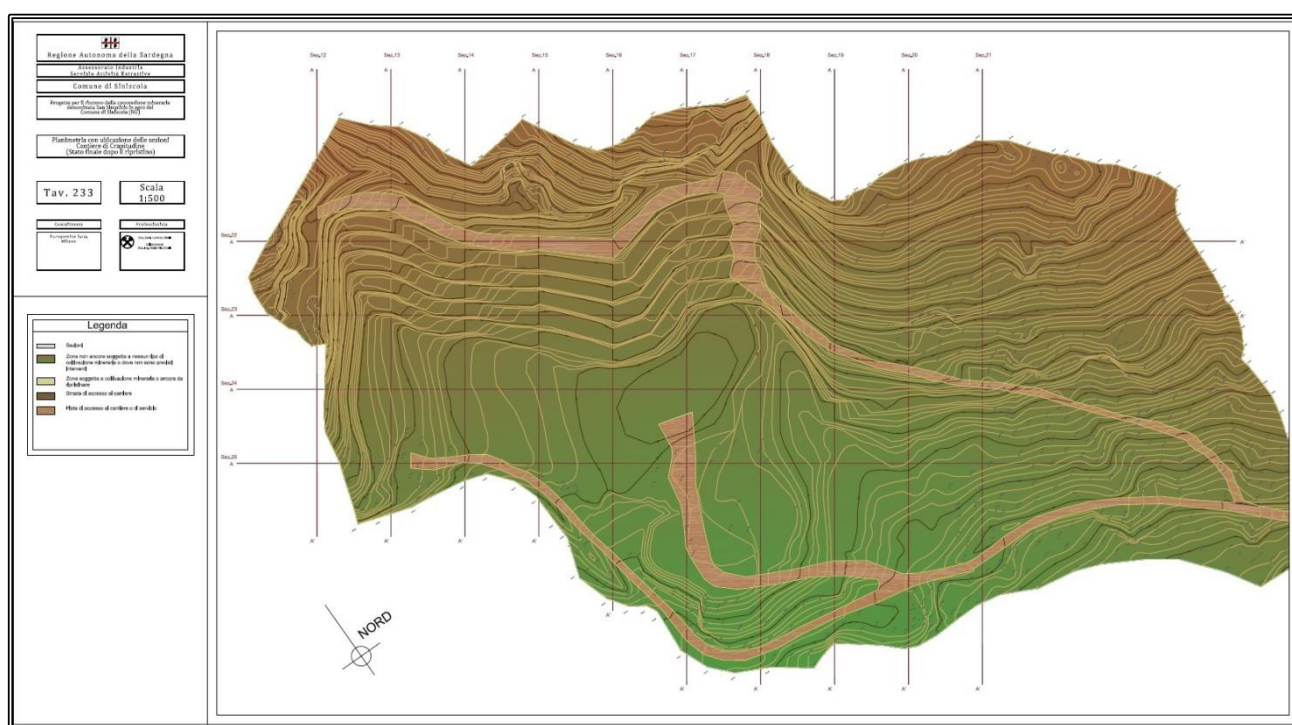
Planimetria dell'area del cantiere di Crapitudine così come nello stato finale dopo la fase di ripristino.
